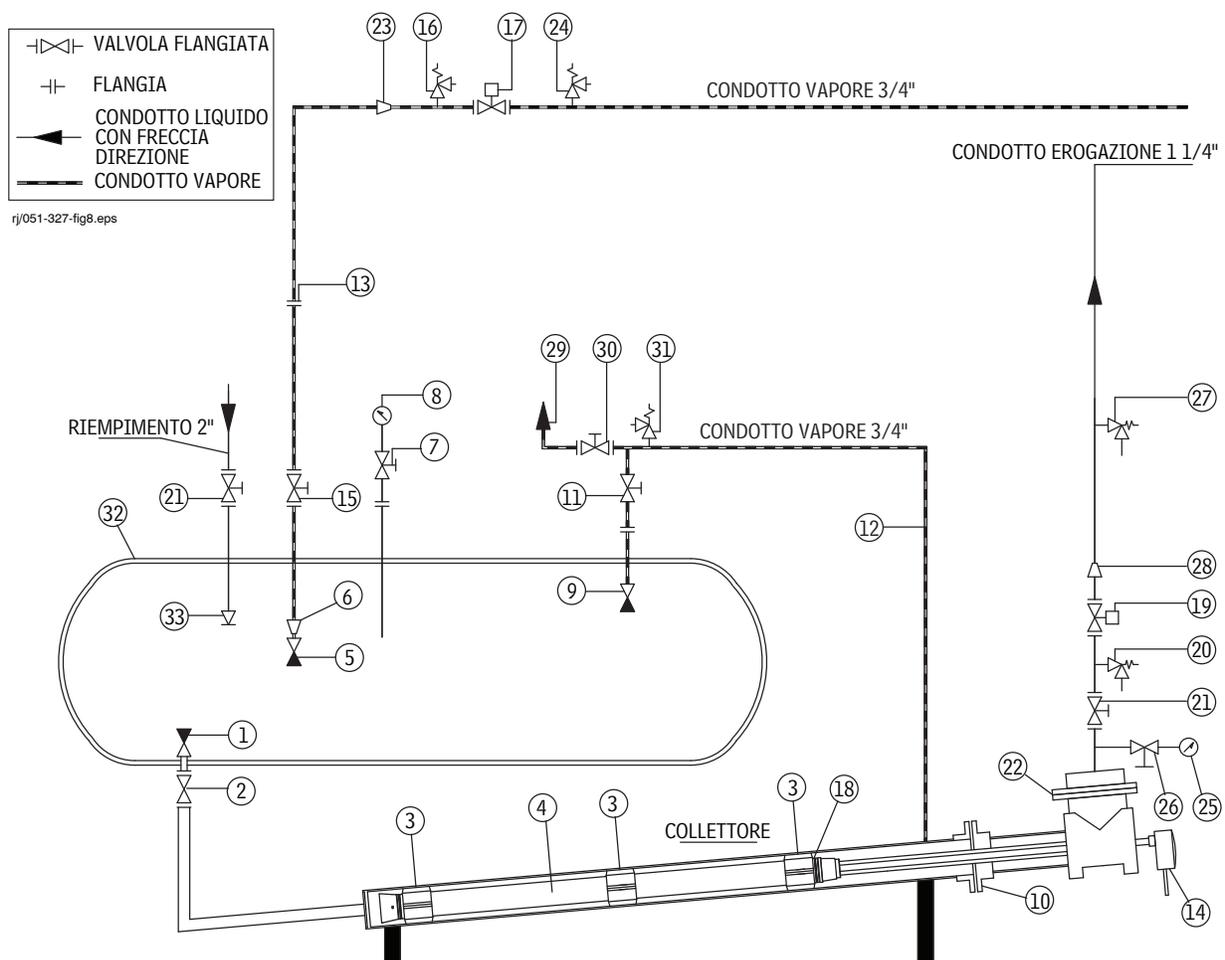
Collettore orizzontale con unità pompa motore per GPL Red Jacket
